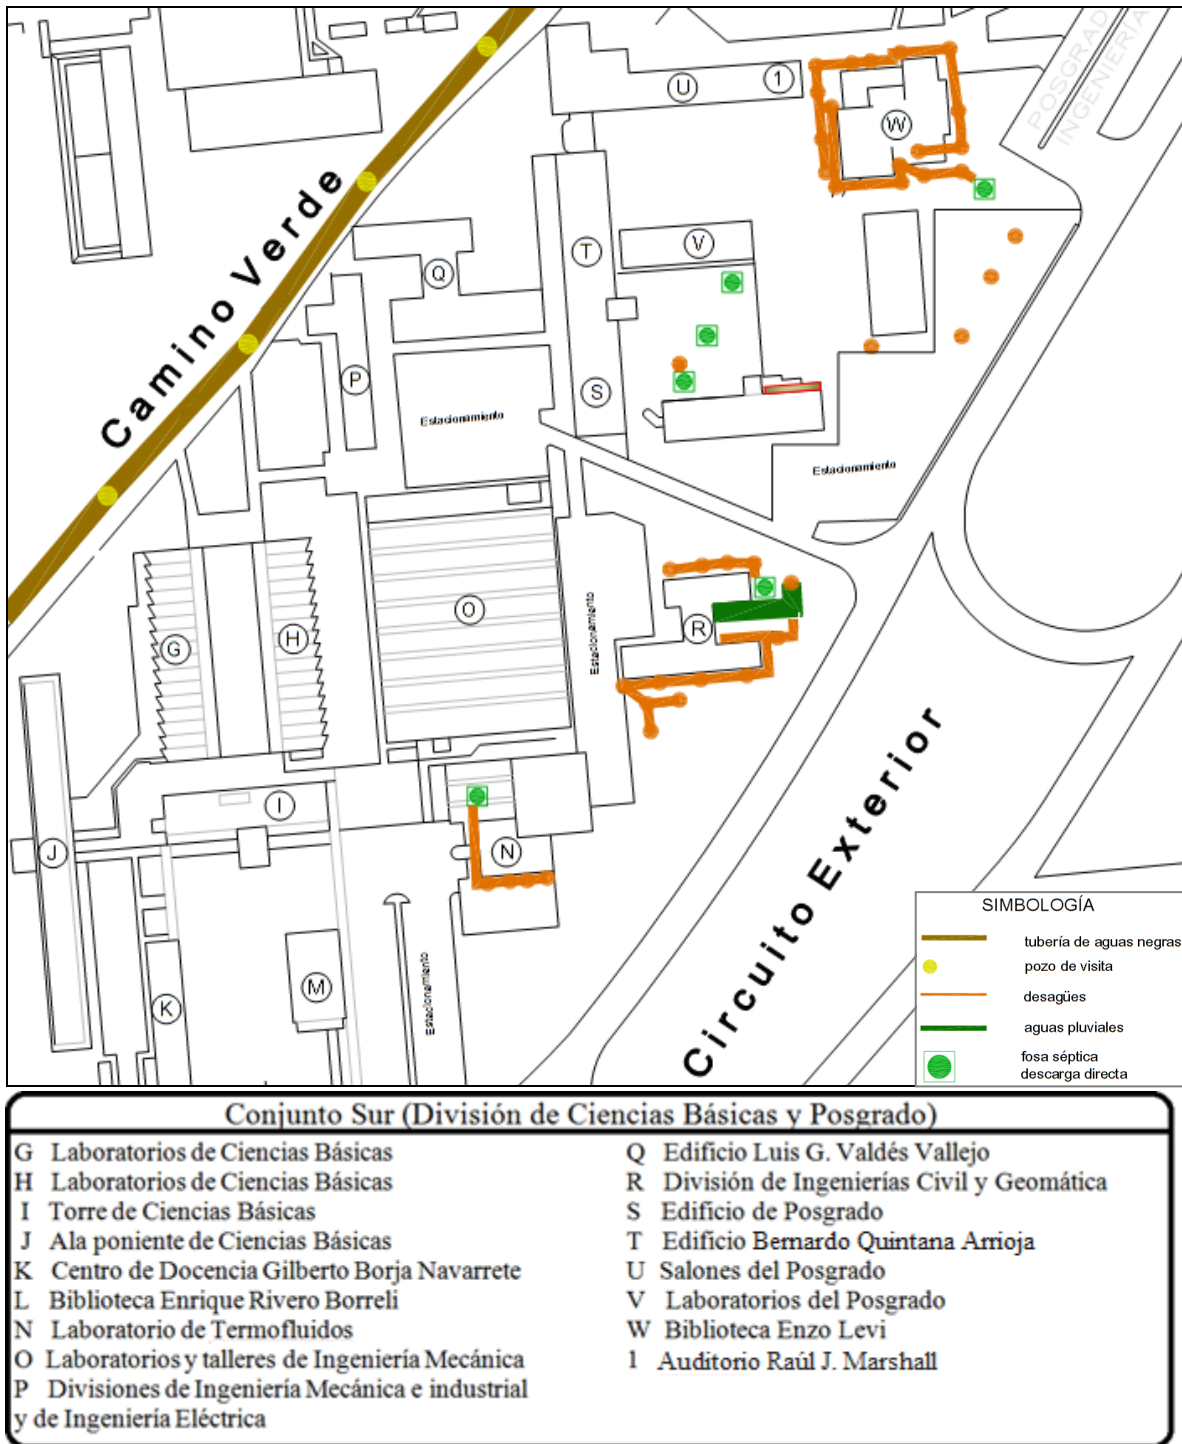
Plano de la red de alcantarillado del Conjunto Sur
